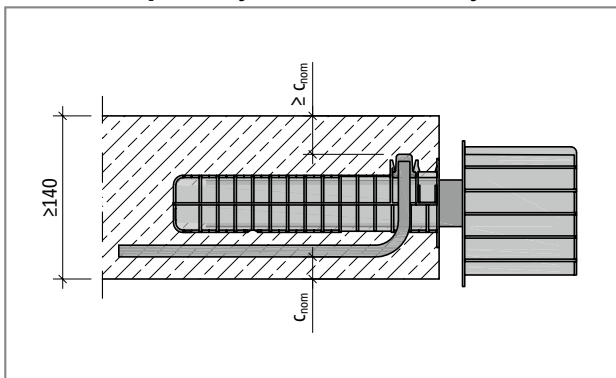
Schöck Tronsole® typ Q: Varianta s tloušťkou spáry ≤ 50 mm
